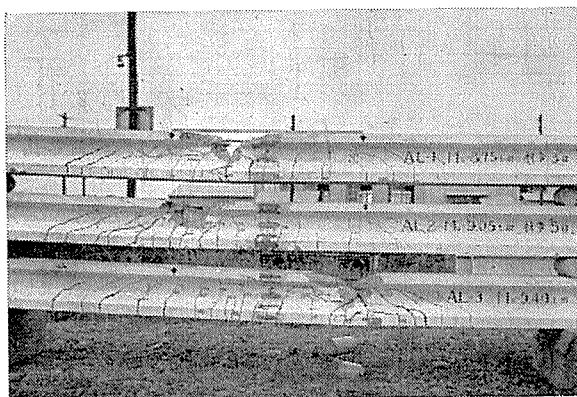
(b) 試験桁ひびわれ発生および破壊状況
